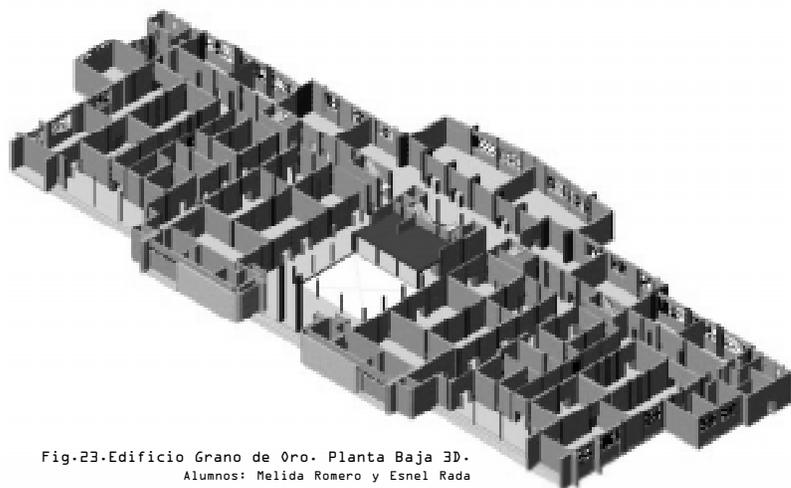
Edificio Grano de Oro. Planta Baja 3D.
